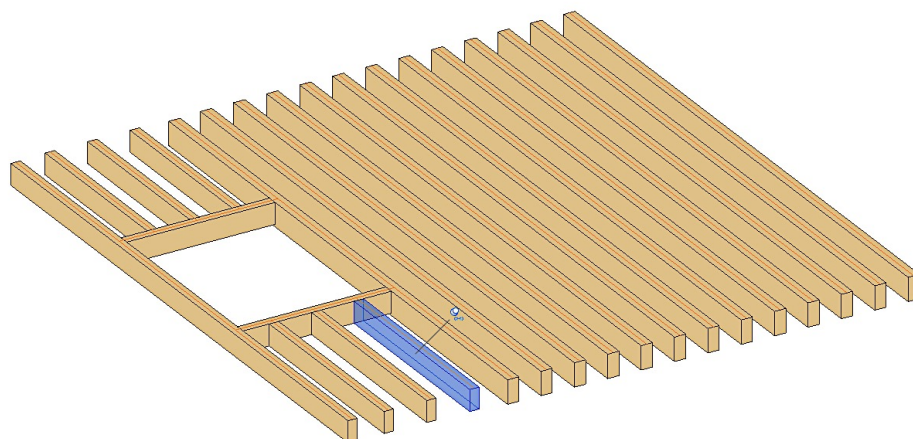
Modelação em Revit do novo pavimento (vigamento) da divisão Norte, lado nascente. Viga V2.
